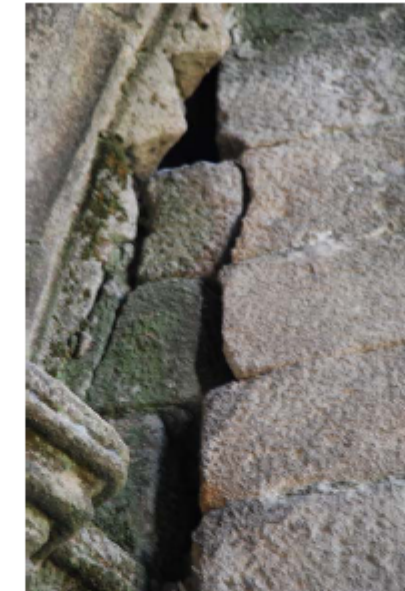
Grieta entre el muro frontal y el ábside 5.
